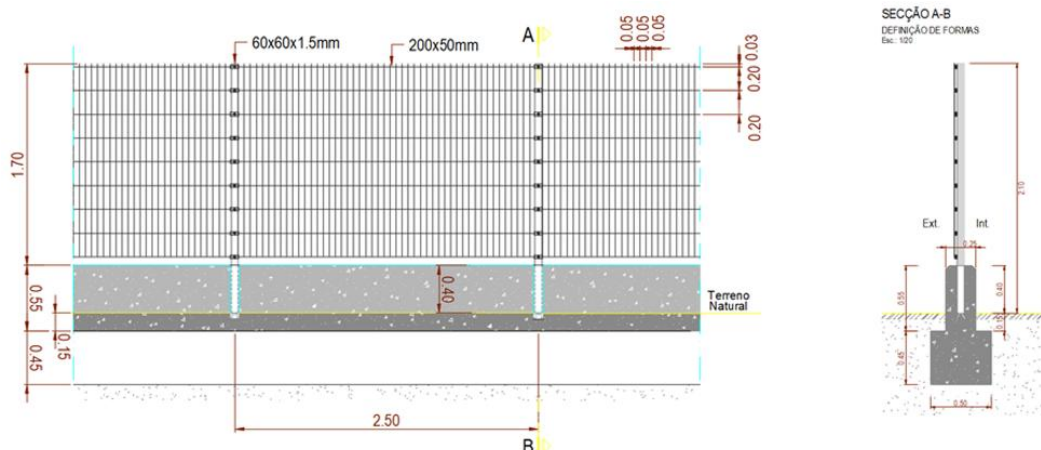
Alçado e corte tipo para vedação em Estações e Apeadeiros
